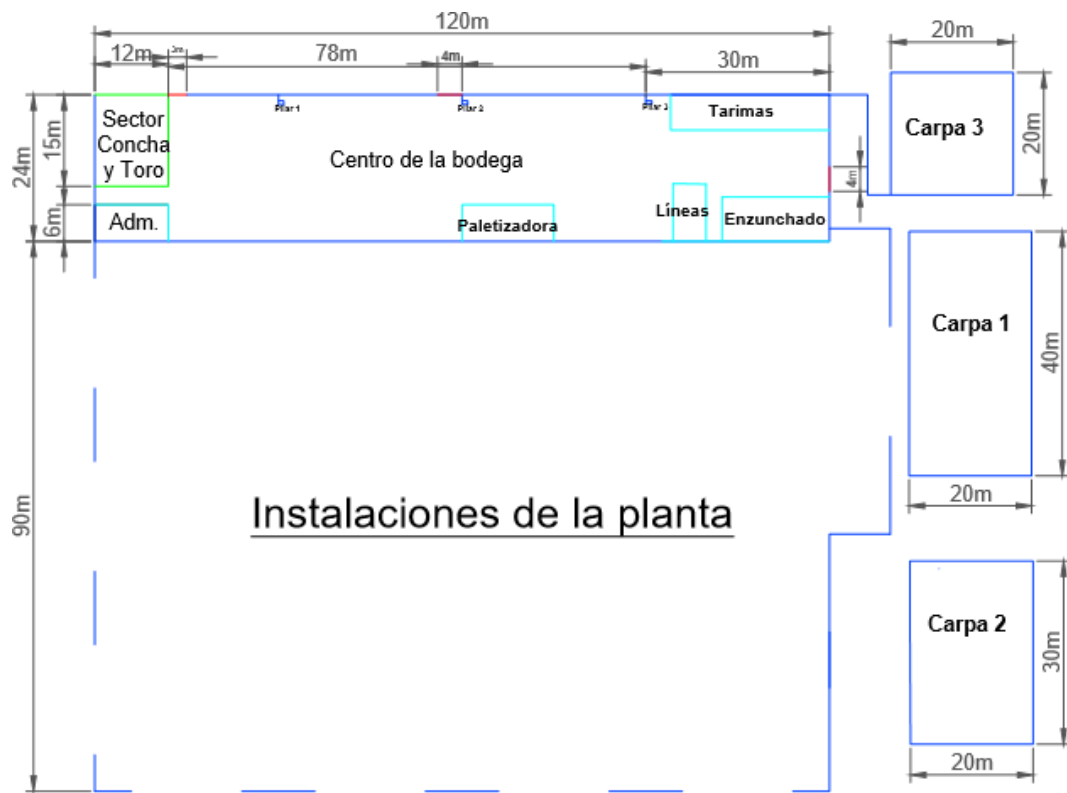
1: Layout bodega Interna y externa planta Til Til
